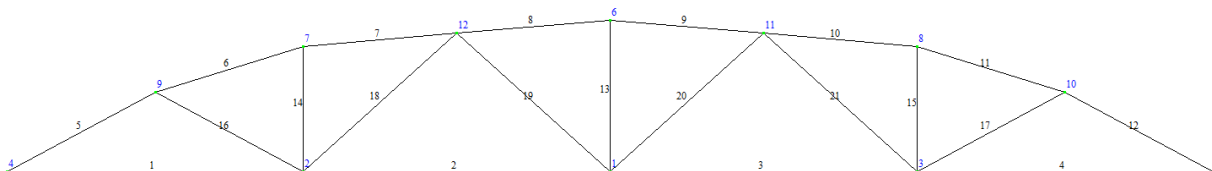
Конечно-элементная модель стропильной фермы ФС1
